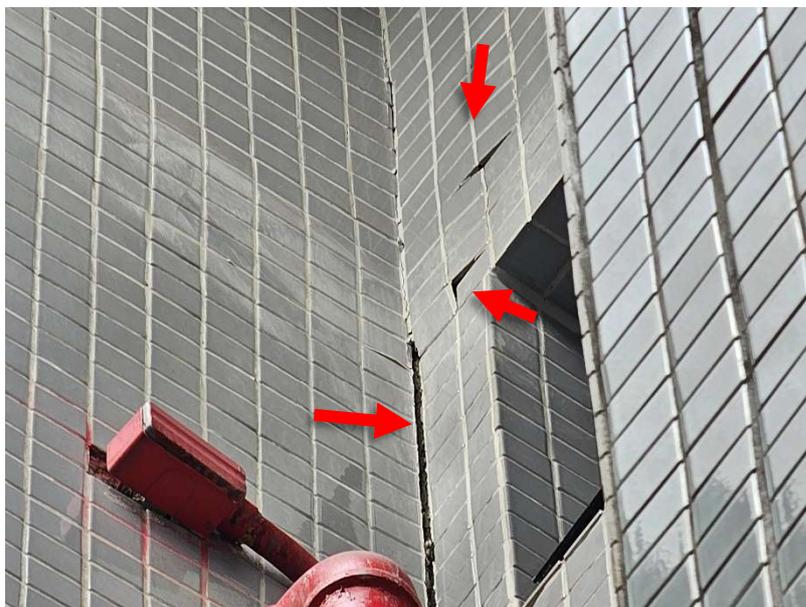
Foi constatado o destacamento dos revestimentos cerâmicos da fachada do bloco principal e rachadura encontro com a alvenaria da passarela.
